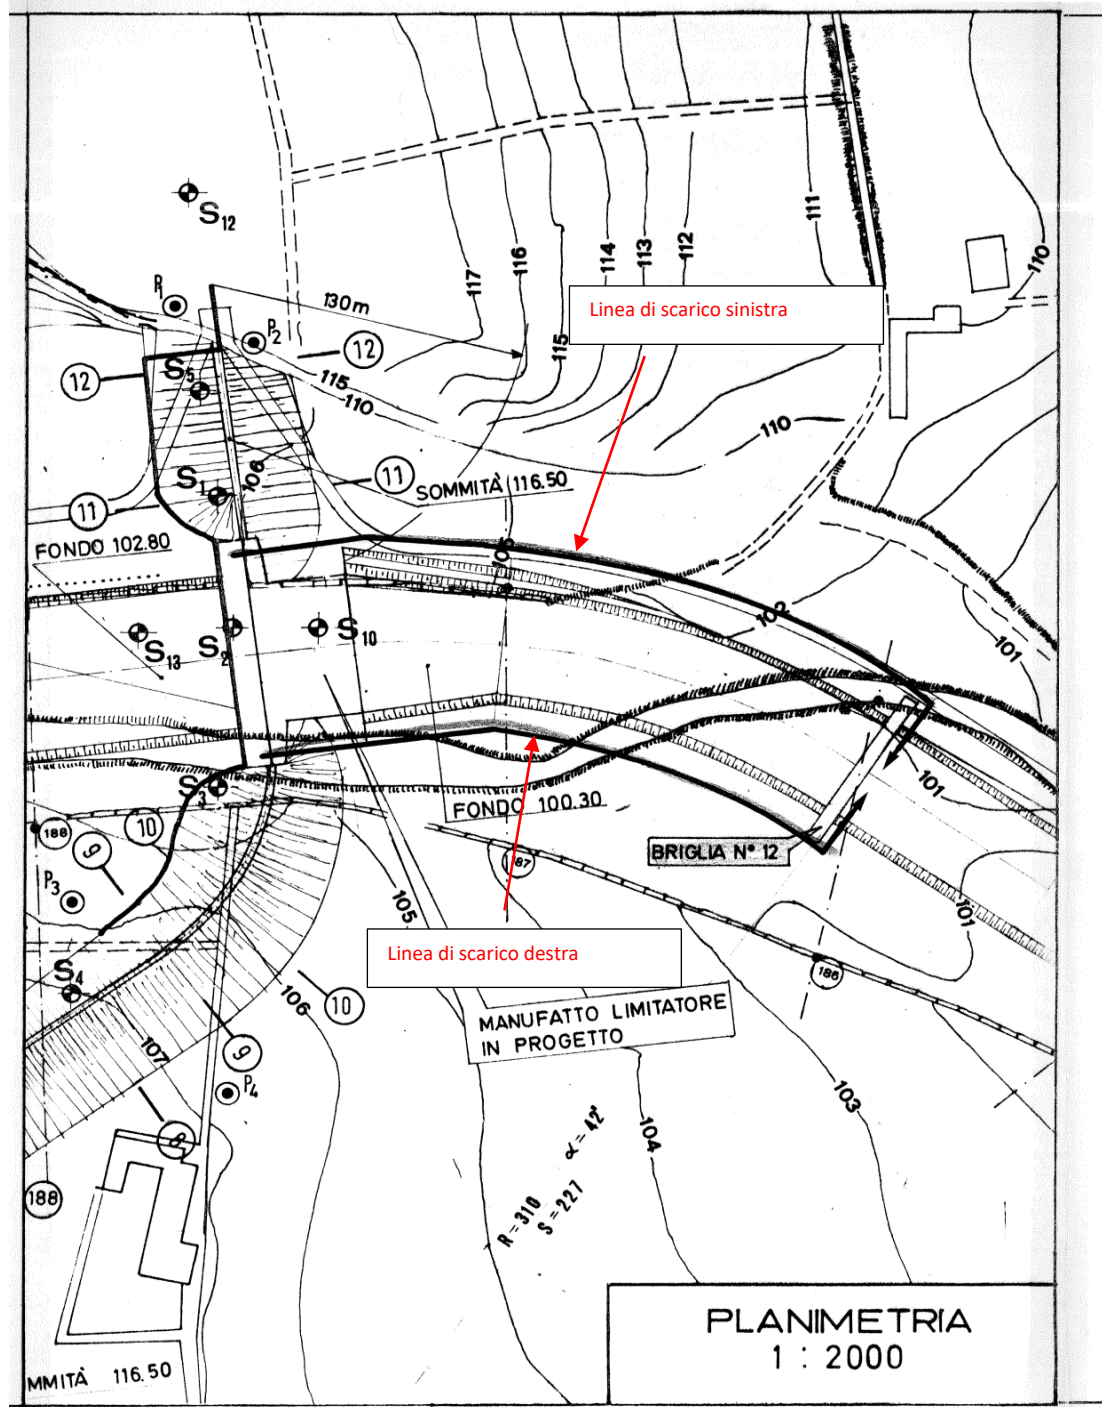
allegato 32 – Tracciato planimetrico linea di scarico
